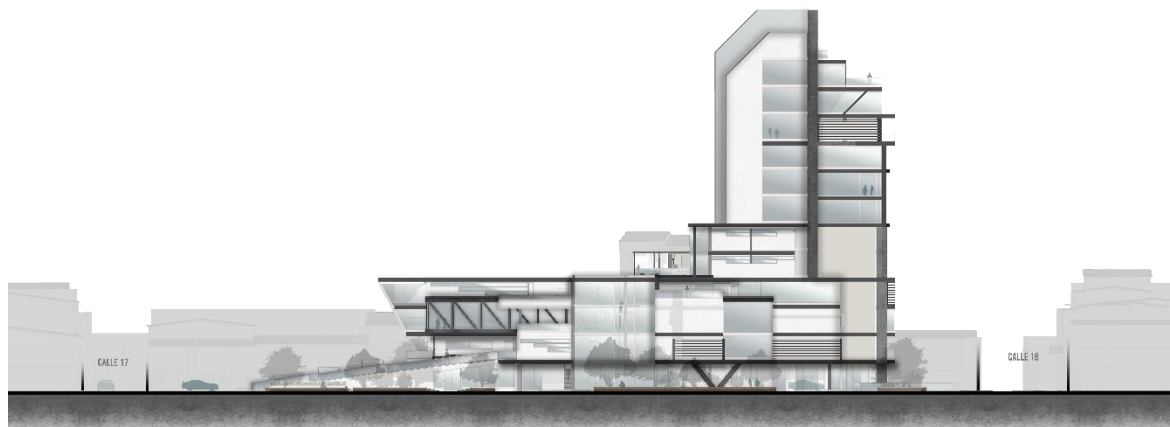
Alzado sur (Cra. 19) – Autoría Propia.
